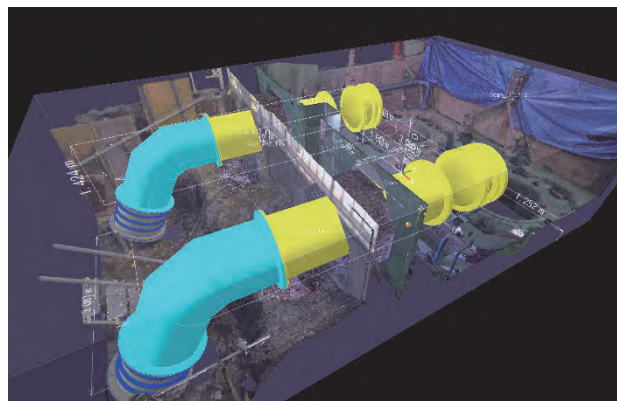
既設吐出管 3Dレーザースキャナ計測状況（上）
